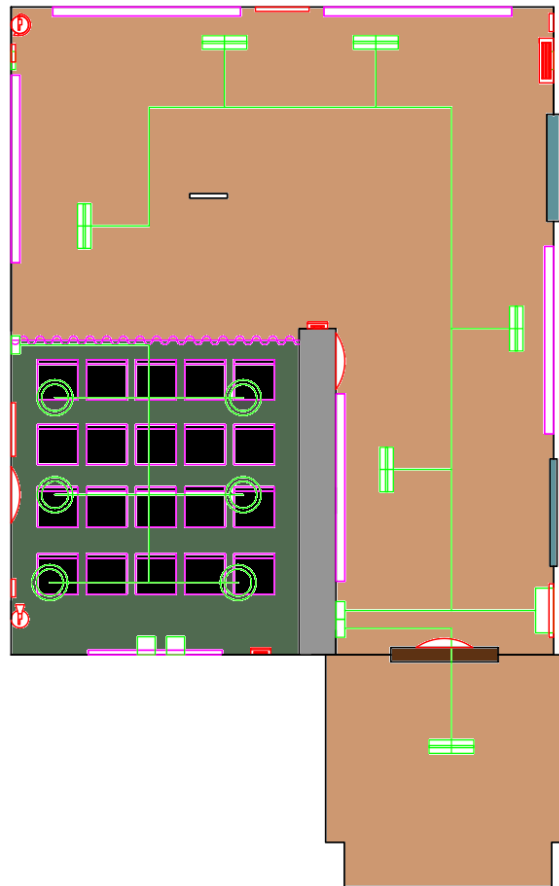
Plano de la caseta UTRANS y de elementos instalados.
